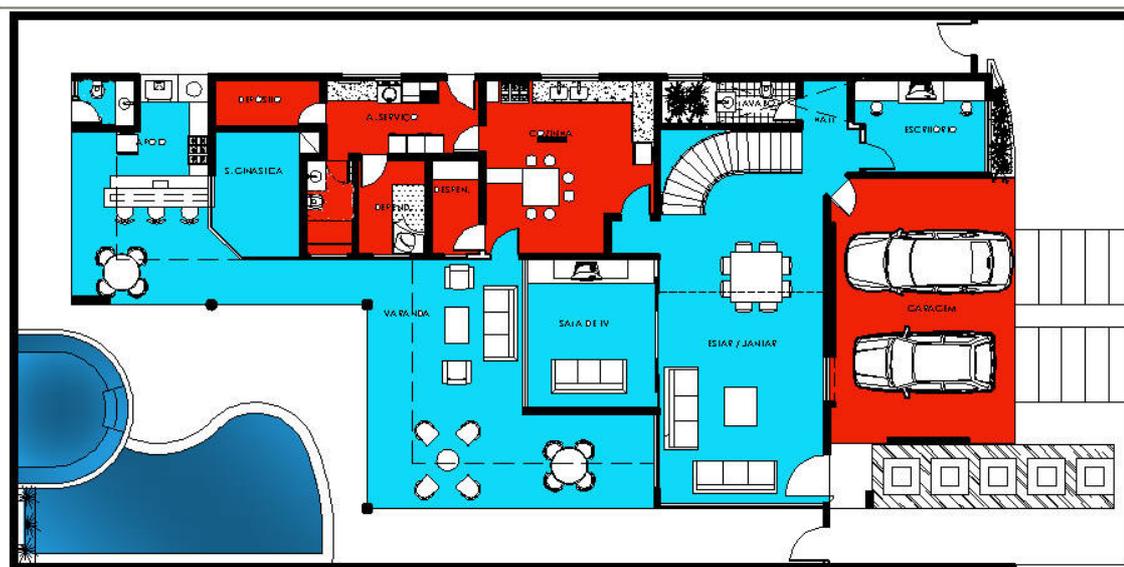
Planta baixa do pavimento térreo (casa 01)
